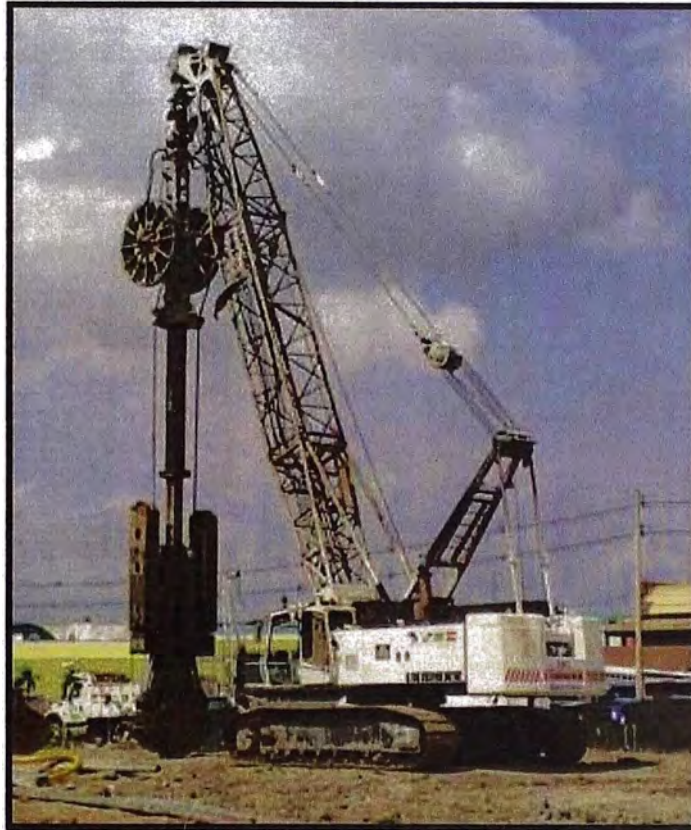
Cucharas Bivalva, utilizado para la construcción de muros pantalla
